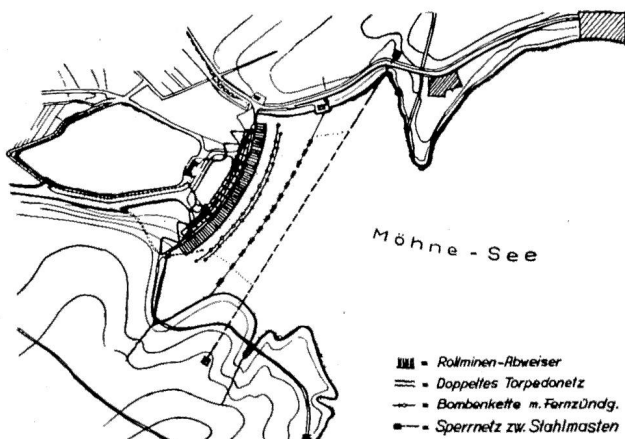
Lageplan der Schutzanlagen an der Möhne-Talsperre.
